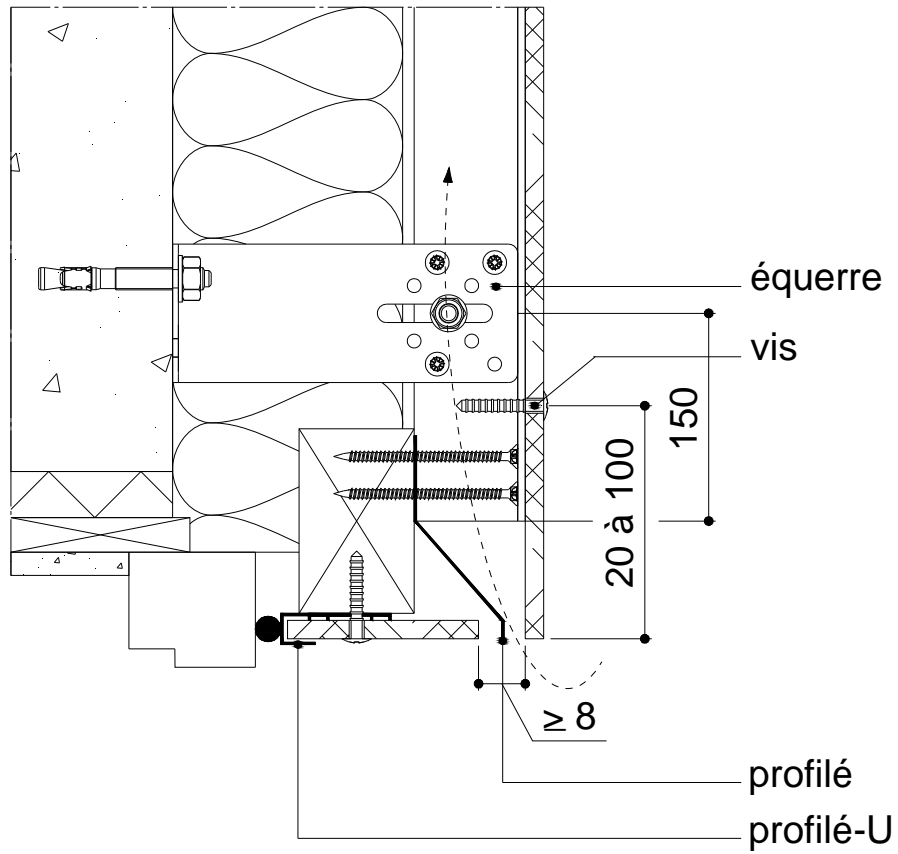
Détail linteau sur ossature bois (cote en mm)
